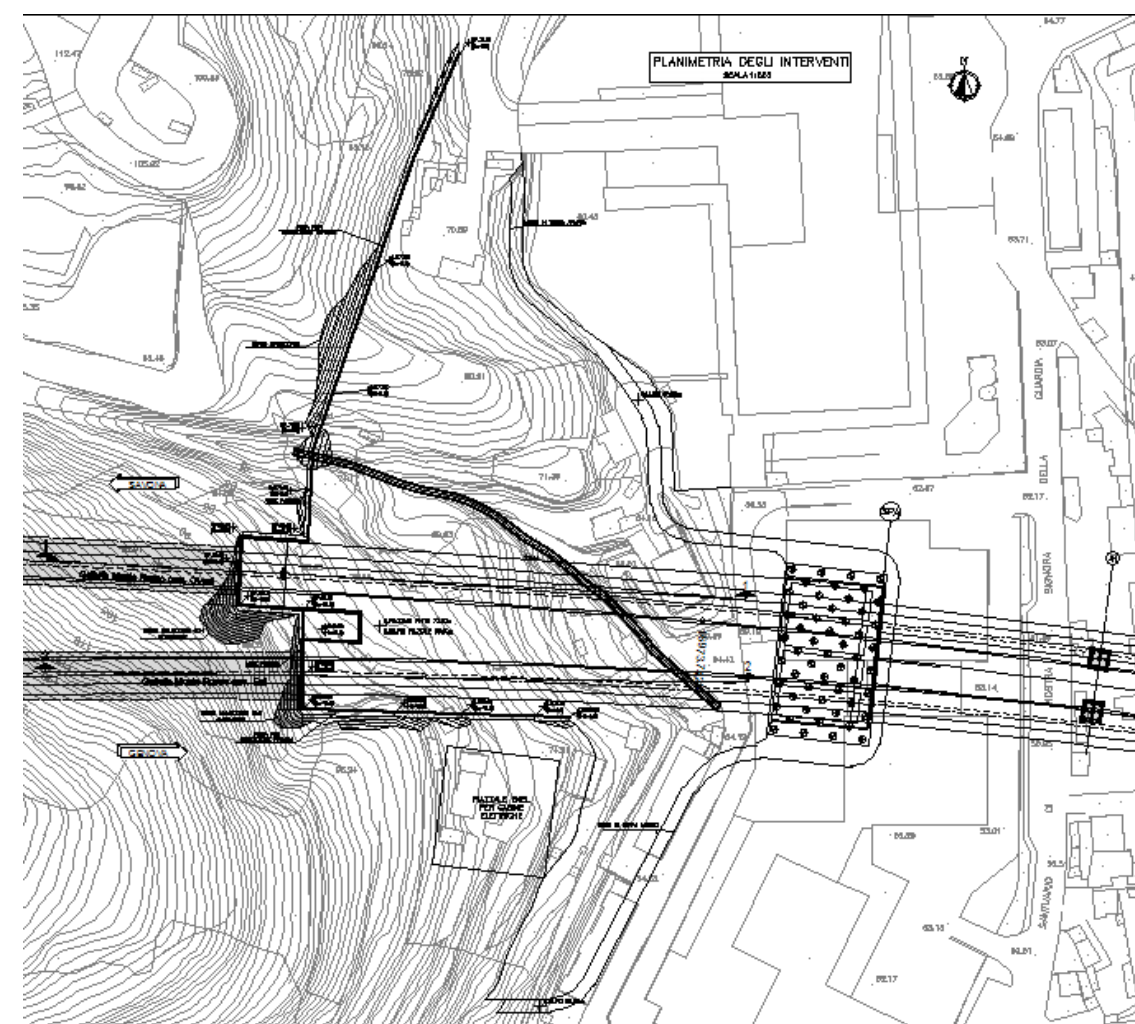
Imbocco galleria Monterosso - Pianta scavi di Progetto Definitivo
